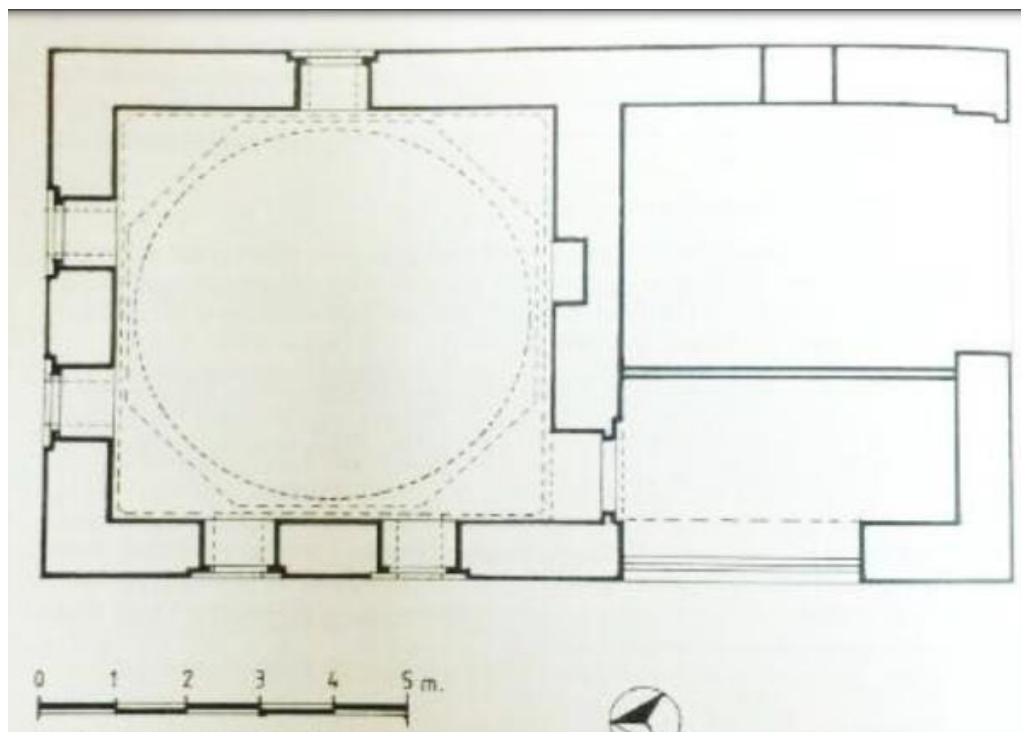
مسقط أفقي لجامع الخاتونية عن:
